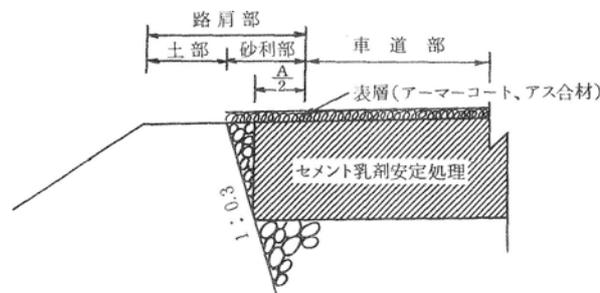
セメント乳剤安定処理及び表層の施工範囲詳細図
